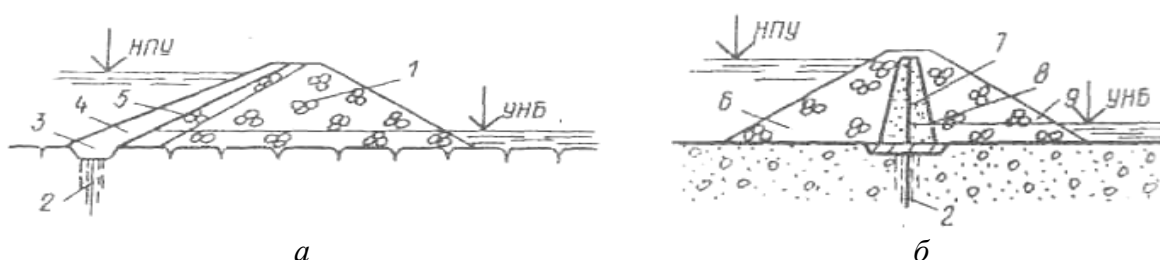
Виды каменно-набросных плотин: а – с экраном из негрунтовых материалов; б – с диафрагмой; 1 – тело плотины; 2 – цементационная завеса; 3 – бетонный зуб; 4 – железобетонный экран; 5 – подэкрановая кладка; 6 – верховая призма; 7 – диафрагма; 8 – переходные слои; 9 – низовая призма
